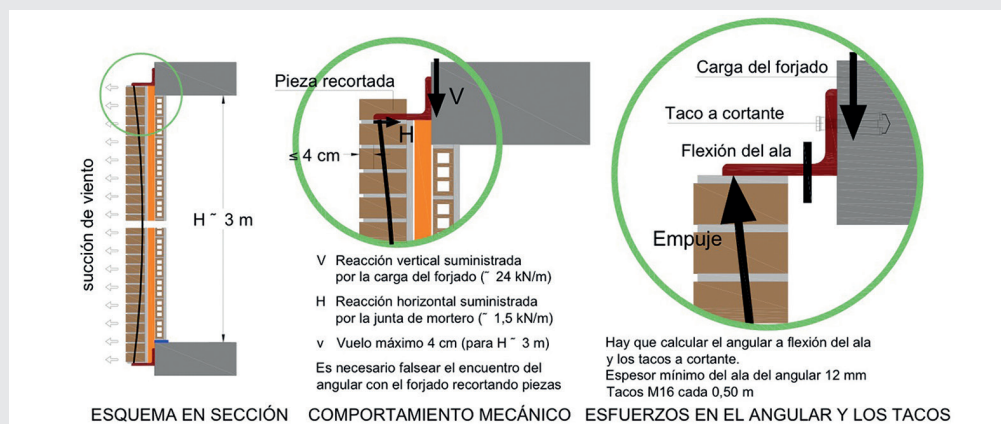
Fachada confinada con angular en forjados (*sistema alternativo al convencional*)
